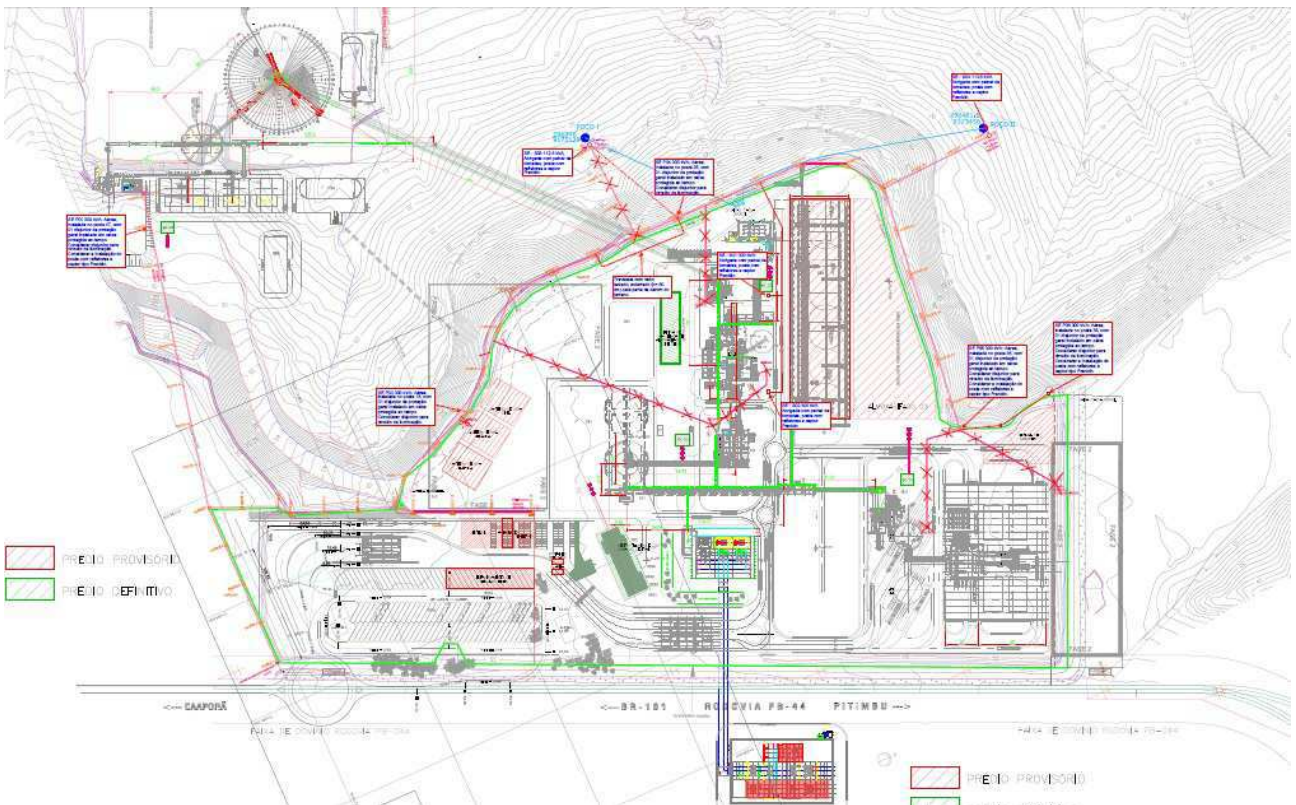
Projeto estrutural do canteiro de obras e infraestrutura da fábrica da Brennand em Pitimbu - PB.
